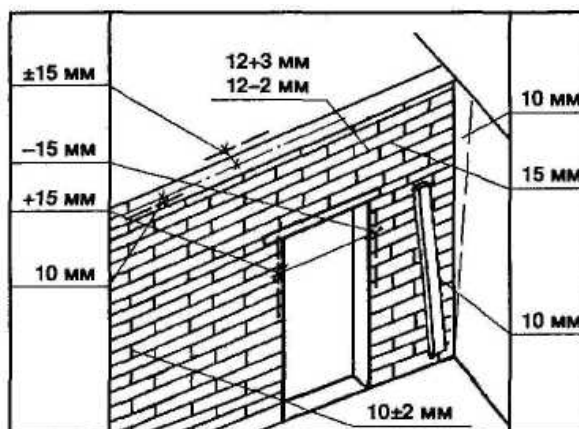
Допускаемые отклонения при кладке перегородок
